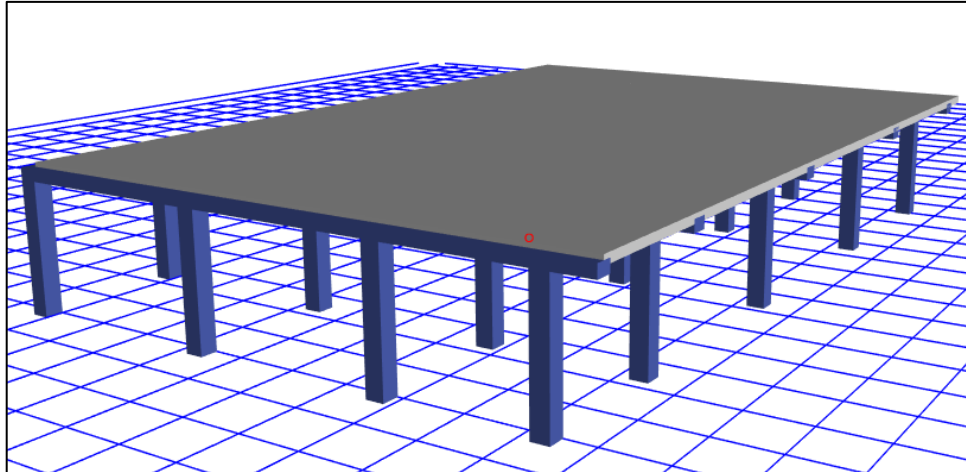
Vista en elevación del modelado en Etabs 2016 de una estructura de un piso
